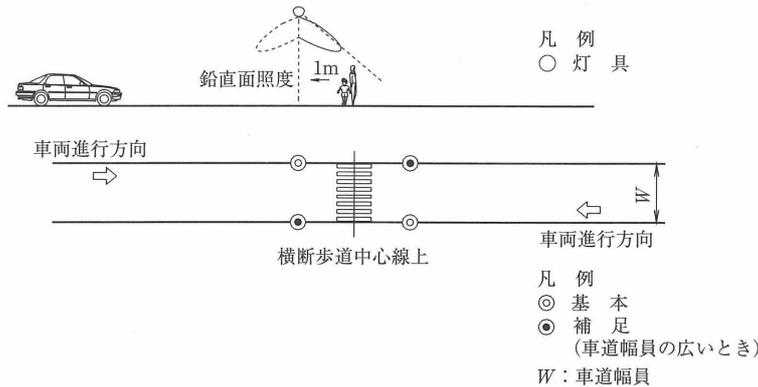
歩行者自身を照明する方式の灯具の配置例⁶⁾
